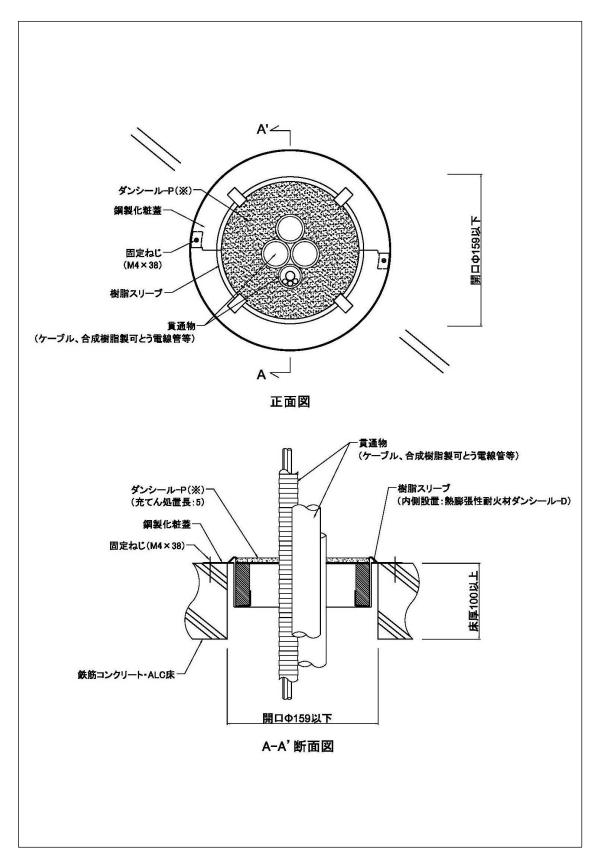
プチロクワイド 標準施工図(鉄筋コンクリート・ALC 床)
